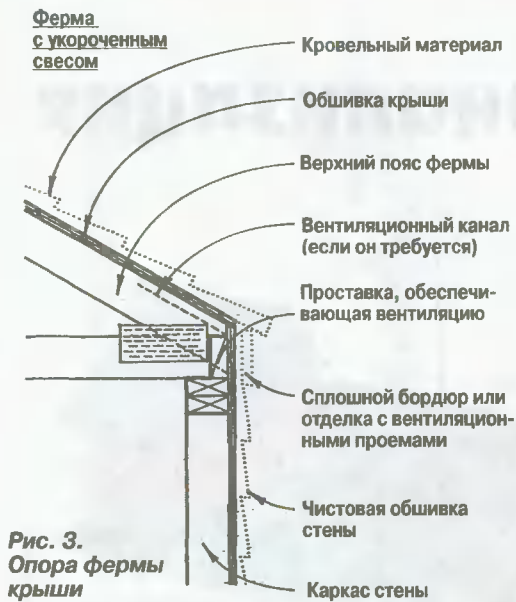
Опора фермы крыши на несущие стены и подшивка свесов
